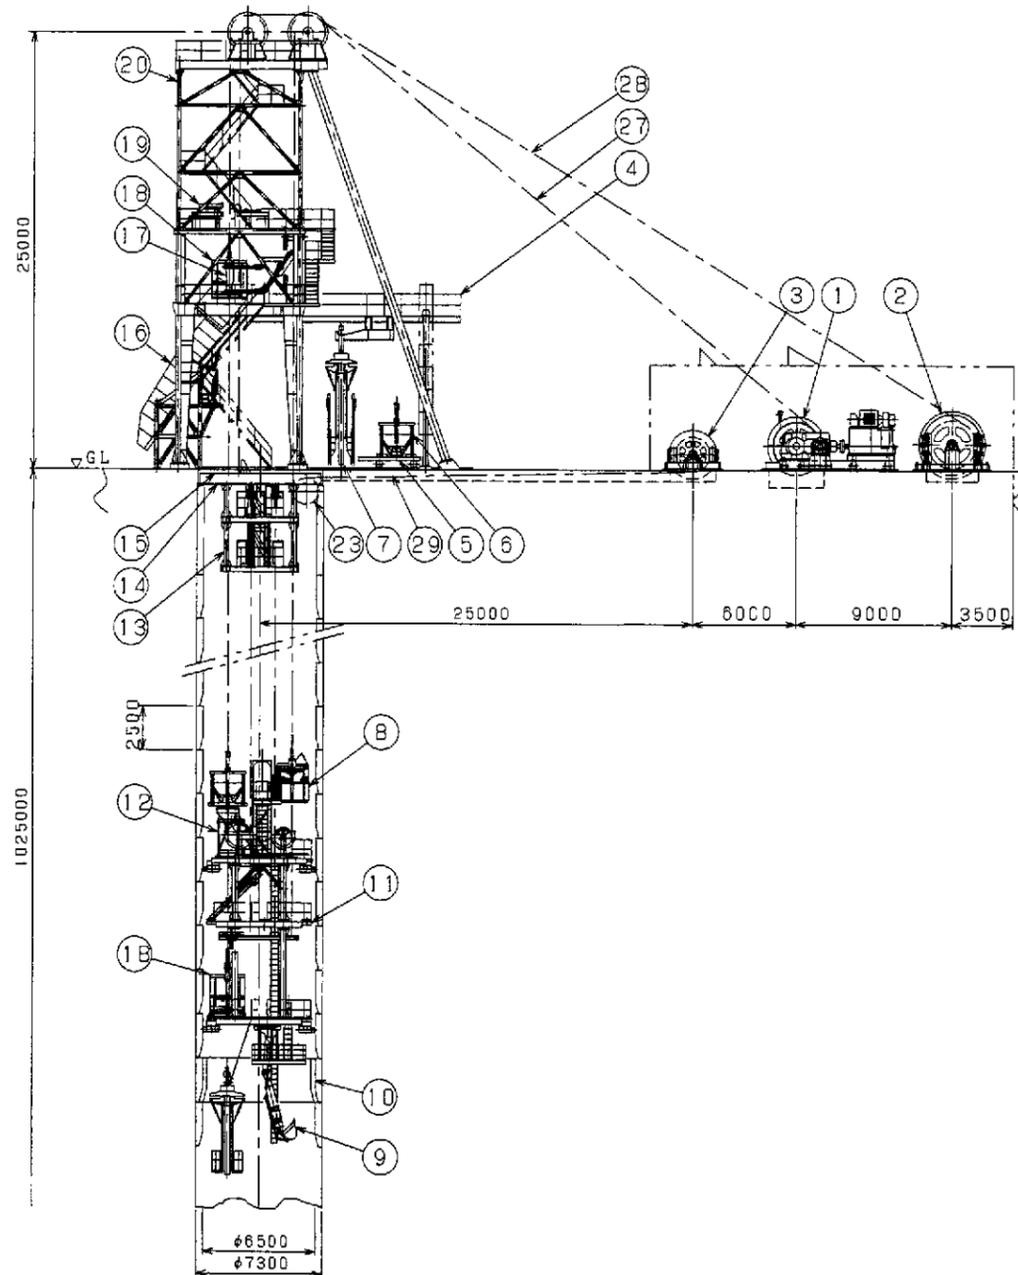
槽設備及び巻上機基礎全体平面図
